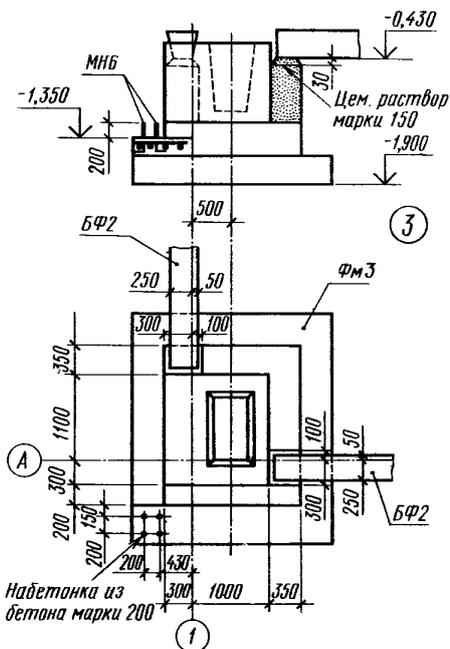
Чертеж узла 3 схемы расположения фундаментов
